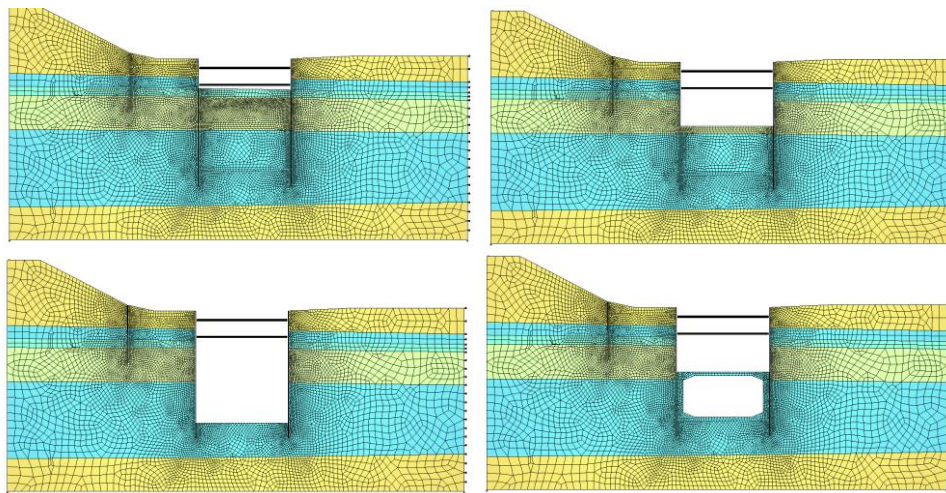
Modelo de elementos finitos elaborado no *SOFiSTiK* – Secção A – faseamento construtivo (2/4)
